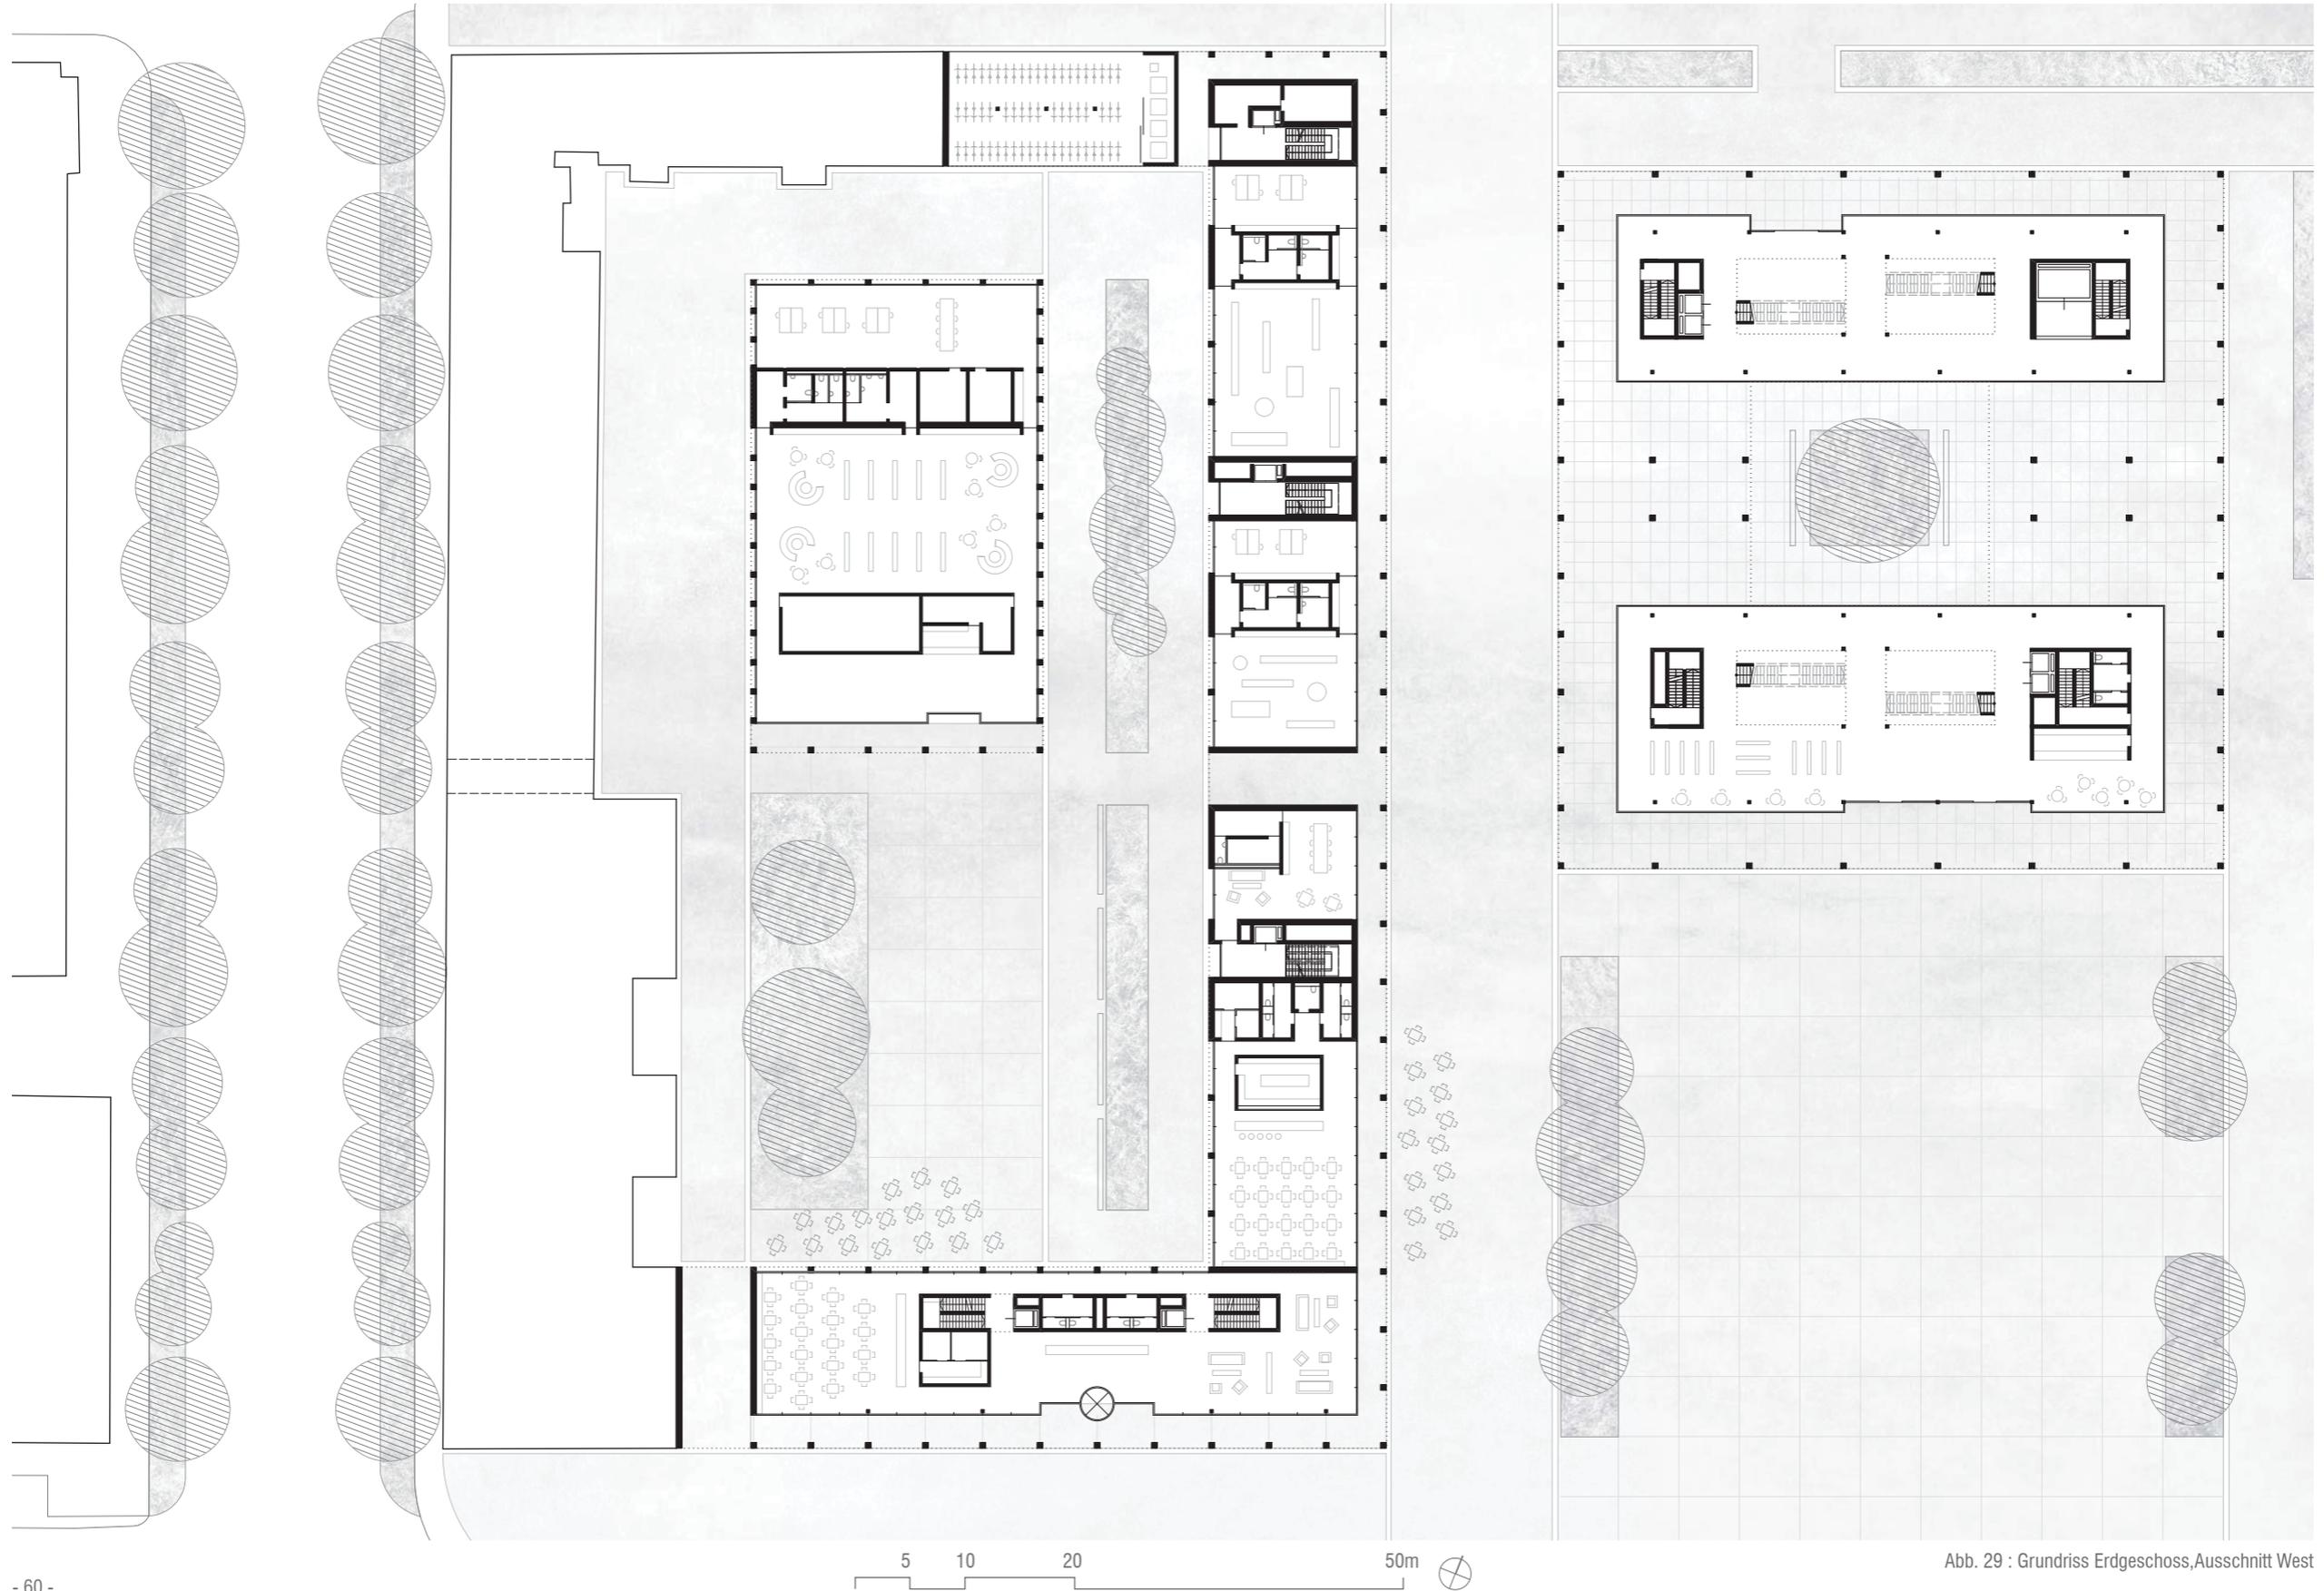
Grundriss Erdgeschoss, Ausschnitt West
